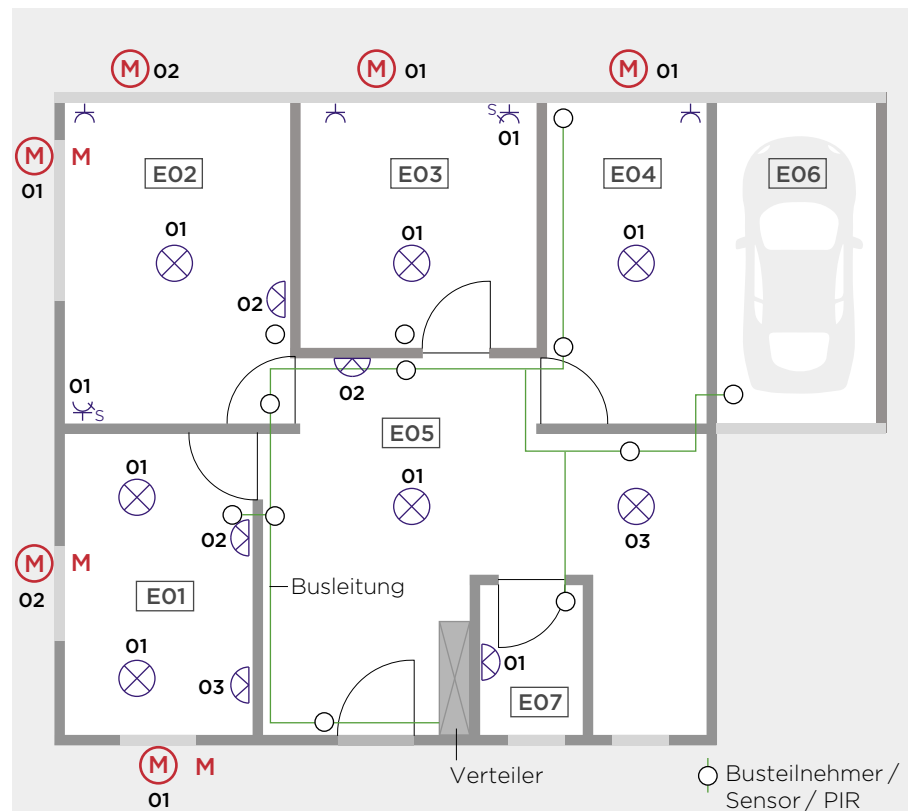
Grundriss mit fortlaufender Nummer pro Gewerk
